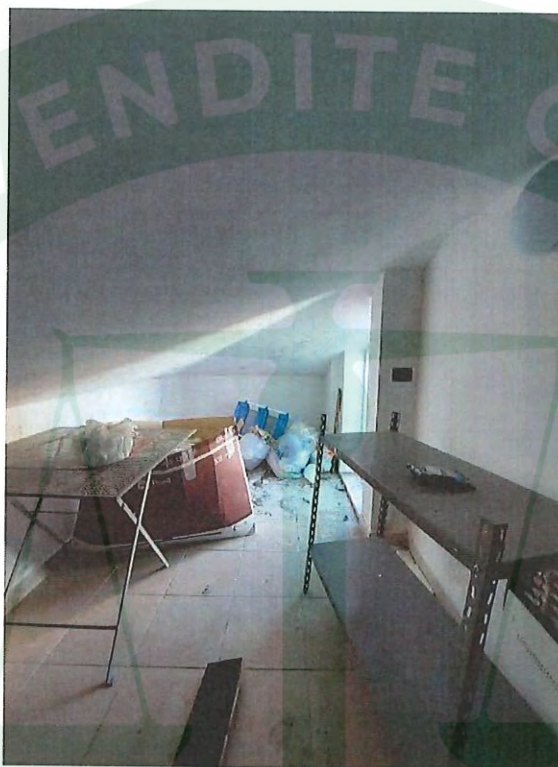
Ripostiglio con ingresso da terrazzo 2
